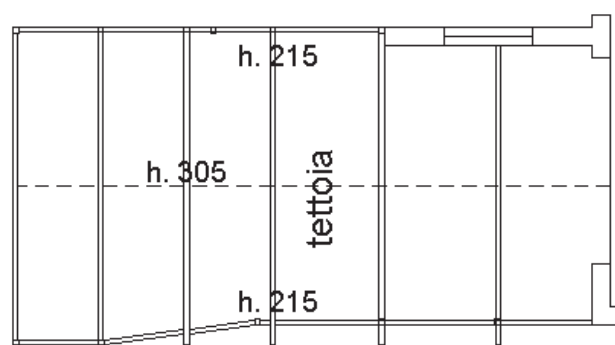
planimetria catastale della tettoia al primo piano – sub 6
